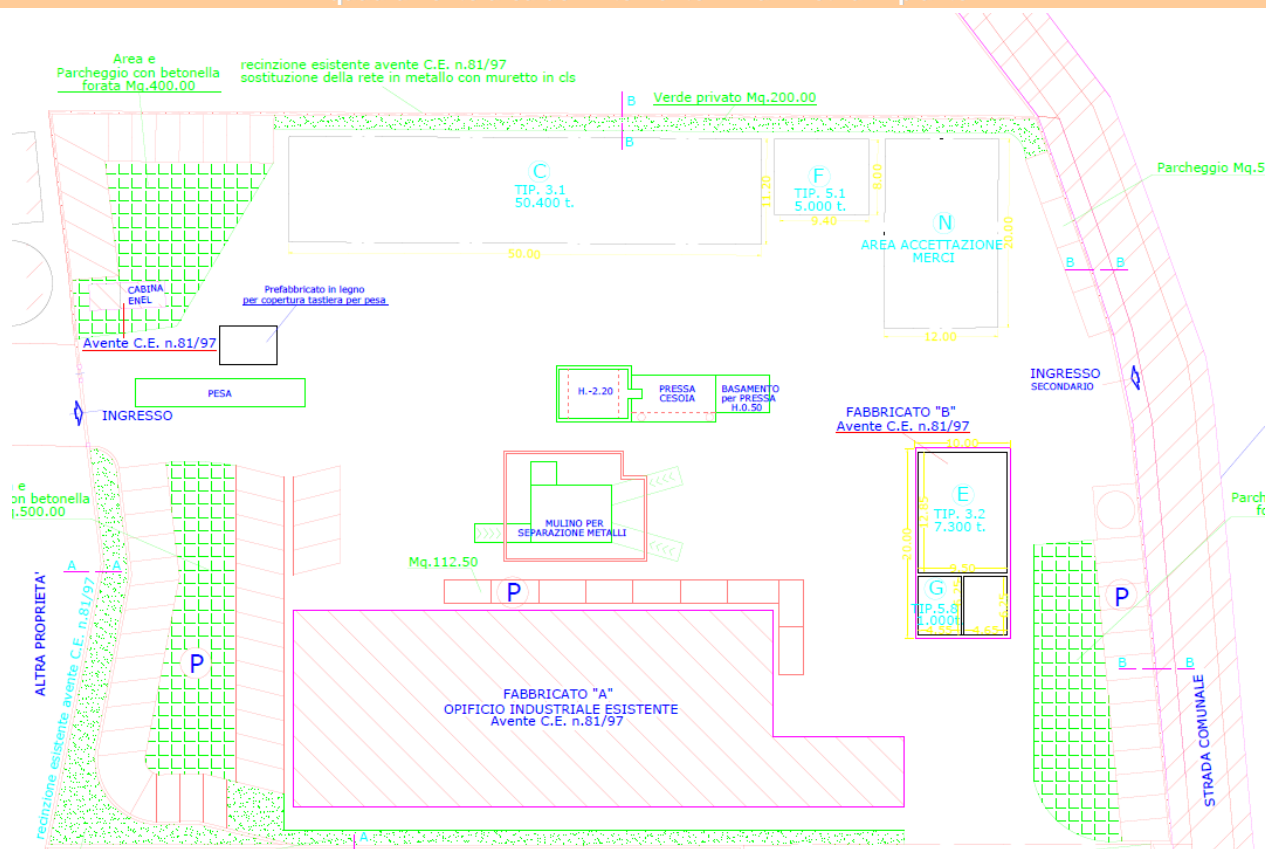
Planimetria area di intervento – Planimetria Impianto
